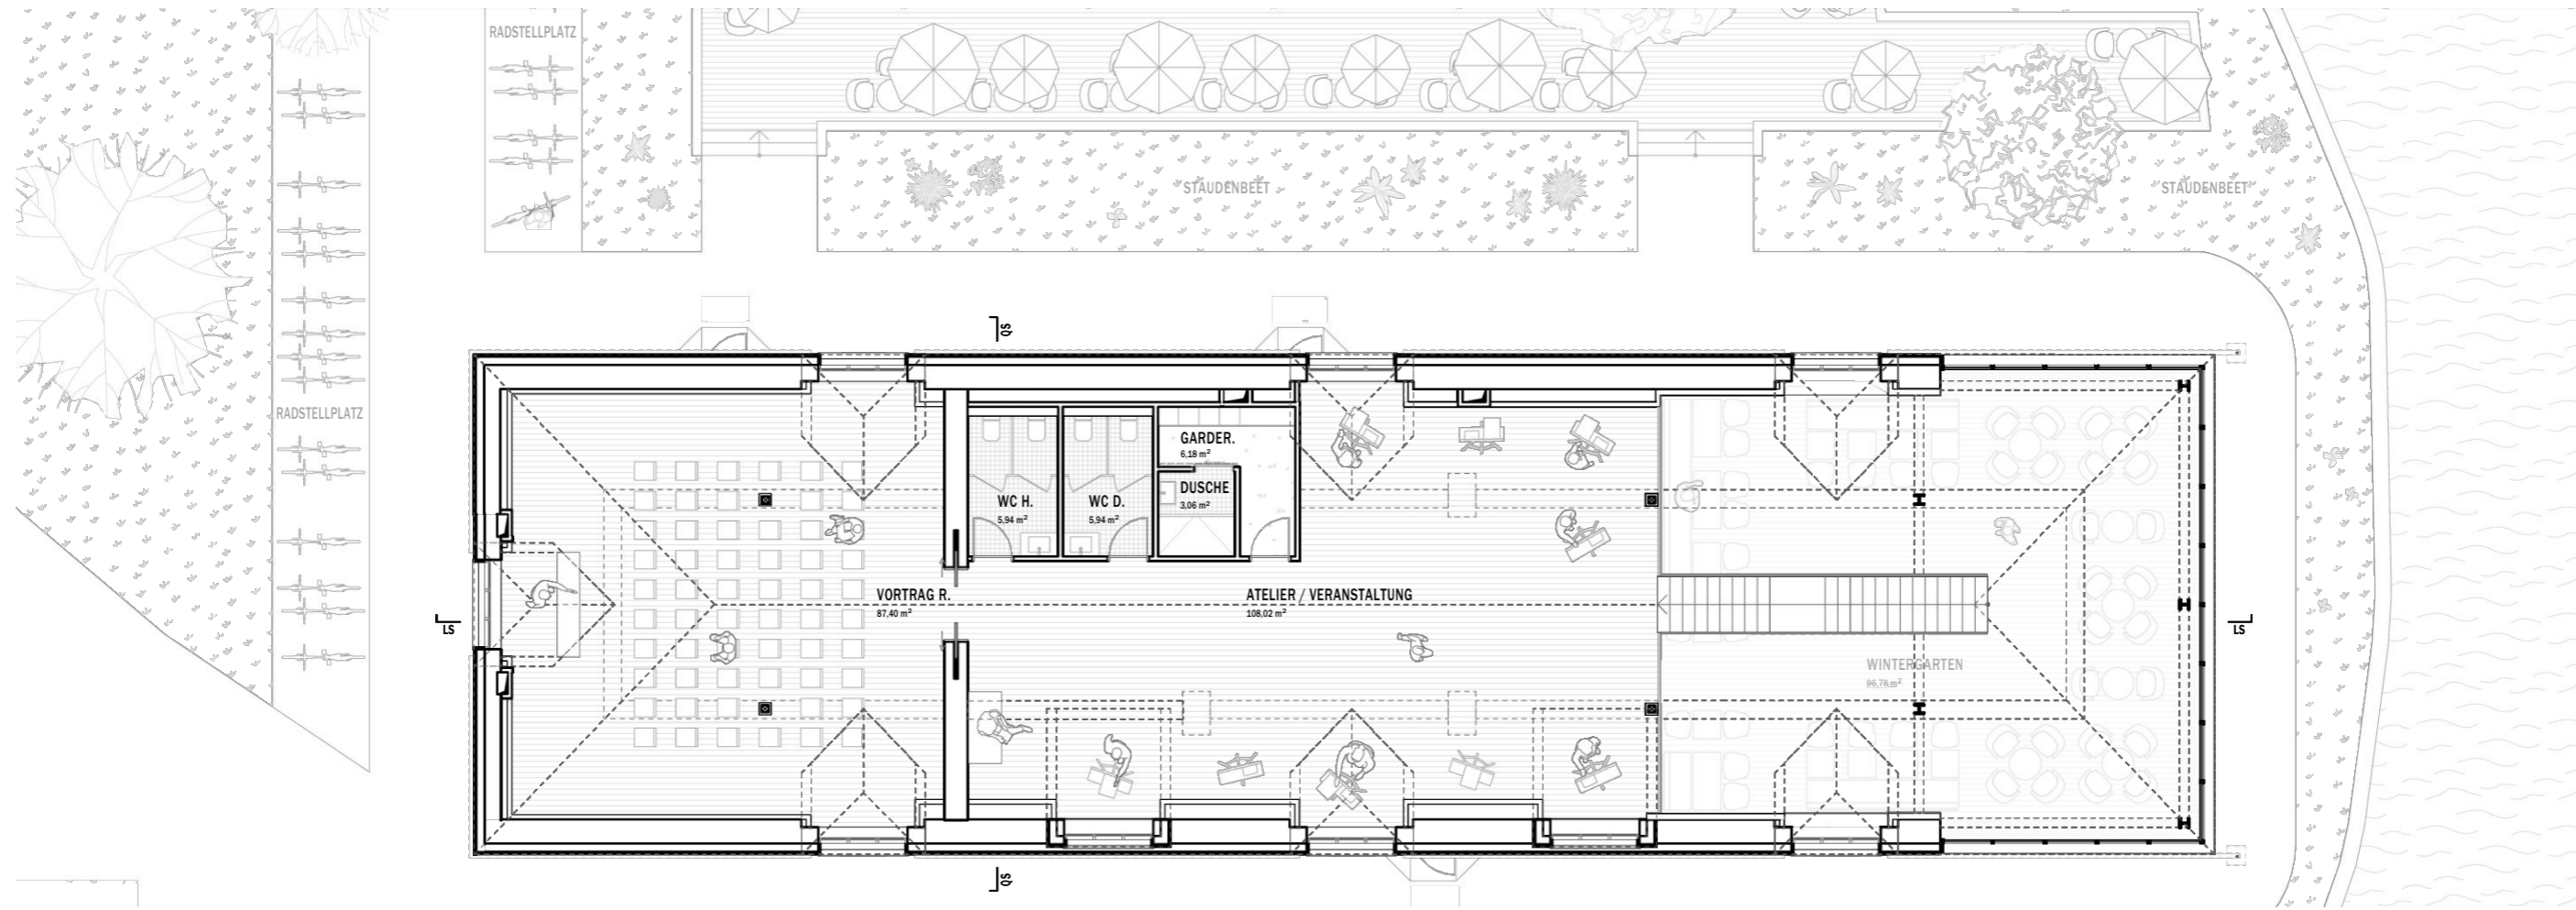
Grundriss OG, Umbau Teichdepot.
